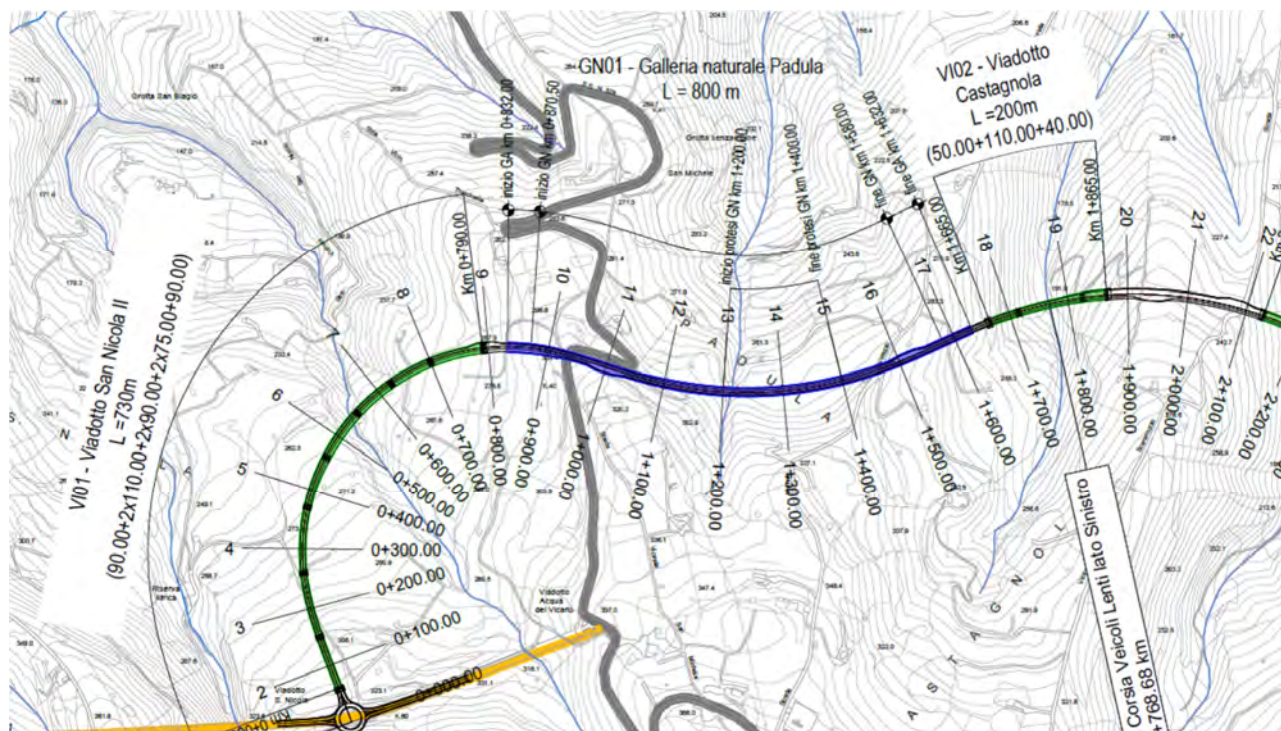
Planimetria semi tratta galleria Padula - T00-PS01-TRA-PF01-A
